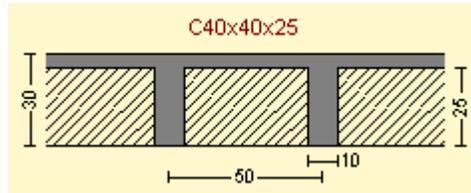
Perfil transversal losa $h=30\text{cm}$.⁸
